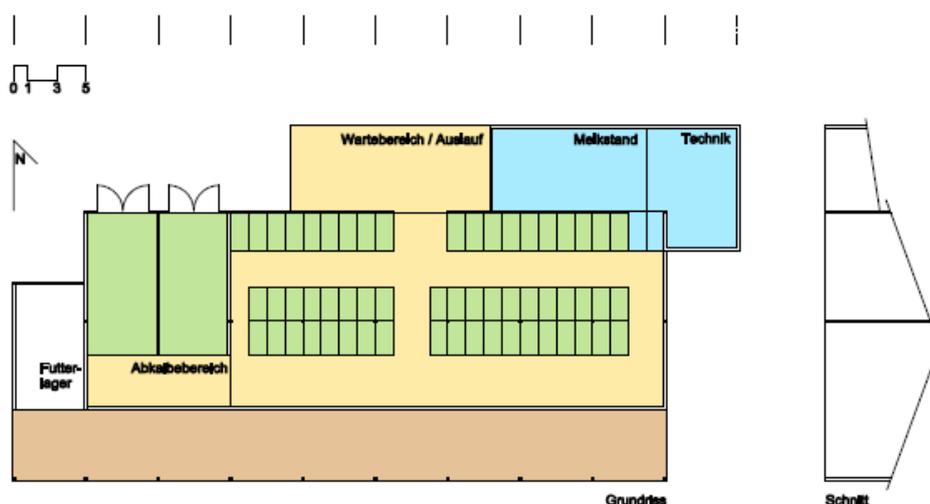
Grundriss und Schnitt, Milchviehstall Betrieb D
